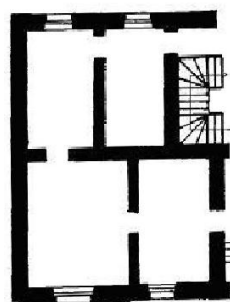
Двокімнатне помешкання анфіладного планування у будинку за адресою Личаківська, 32. 1872 р. (Там само)
